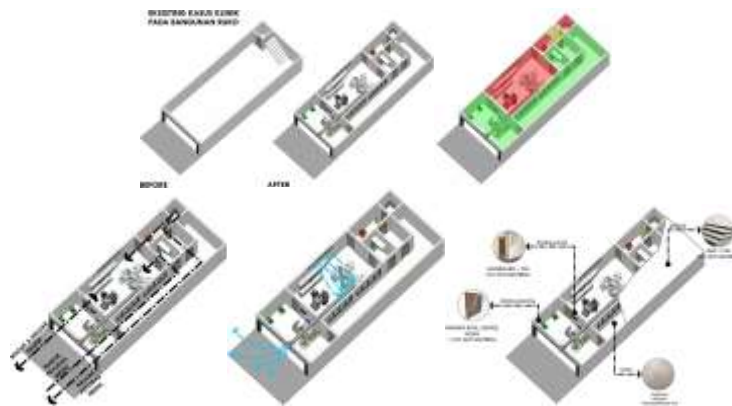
Aplikasi Desain dengan Bangunan Tipe Klinik Eksisting
